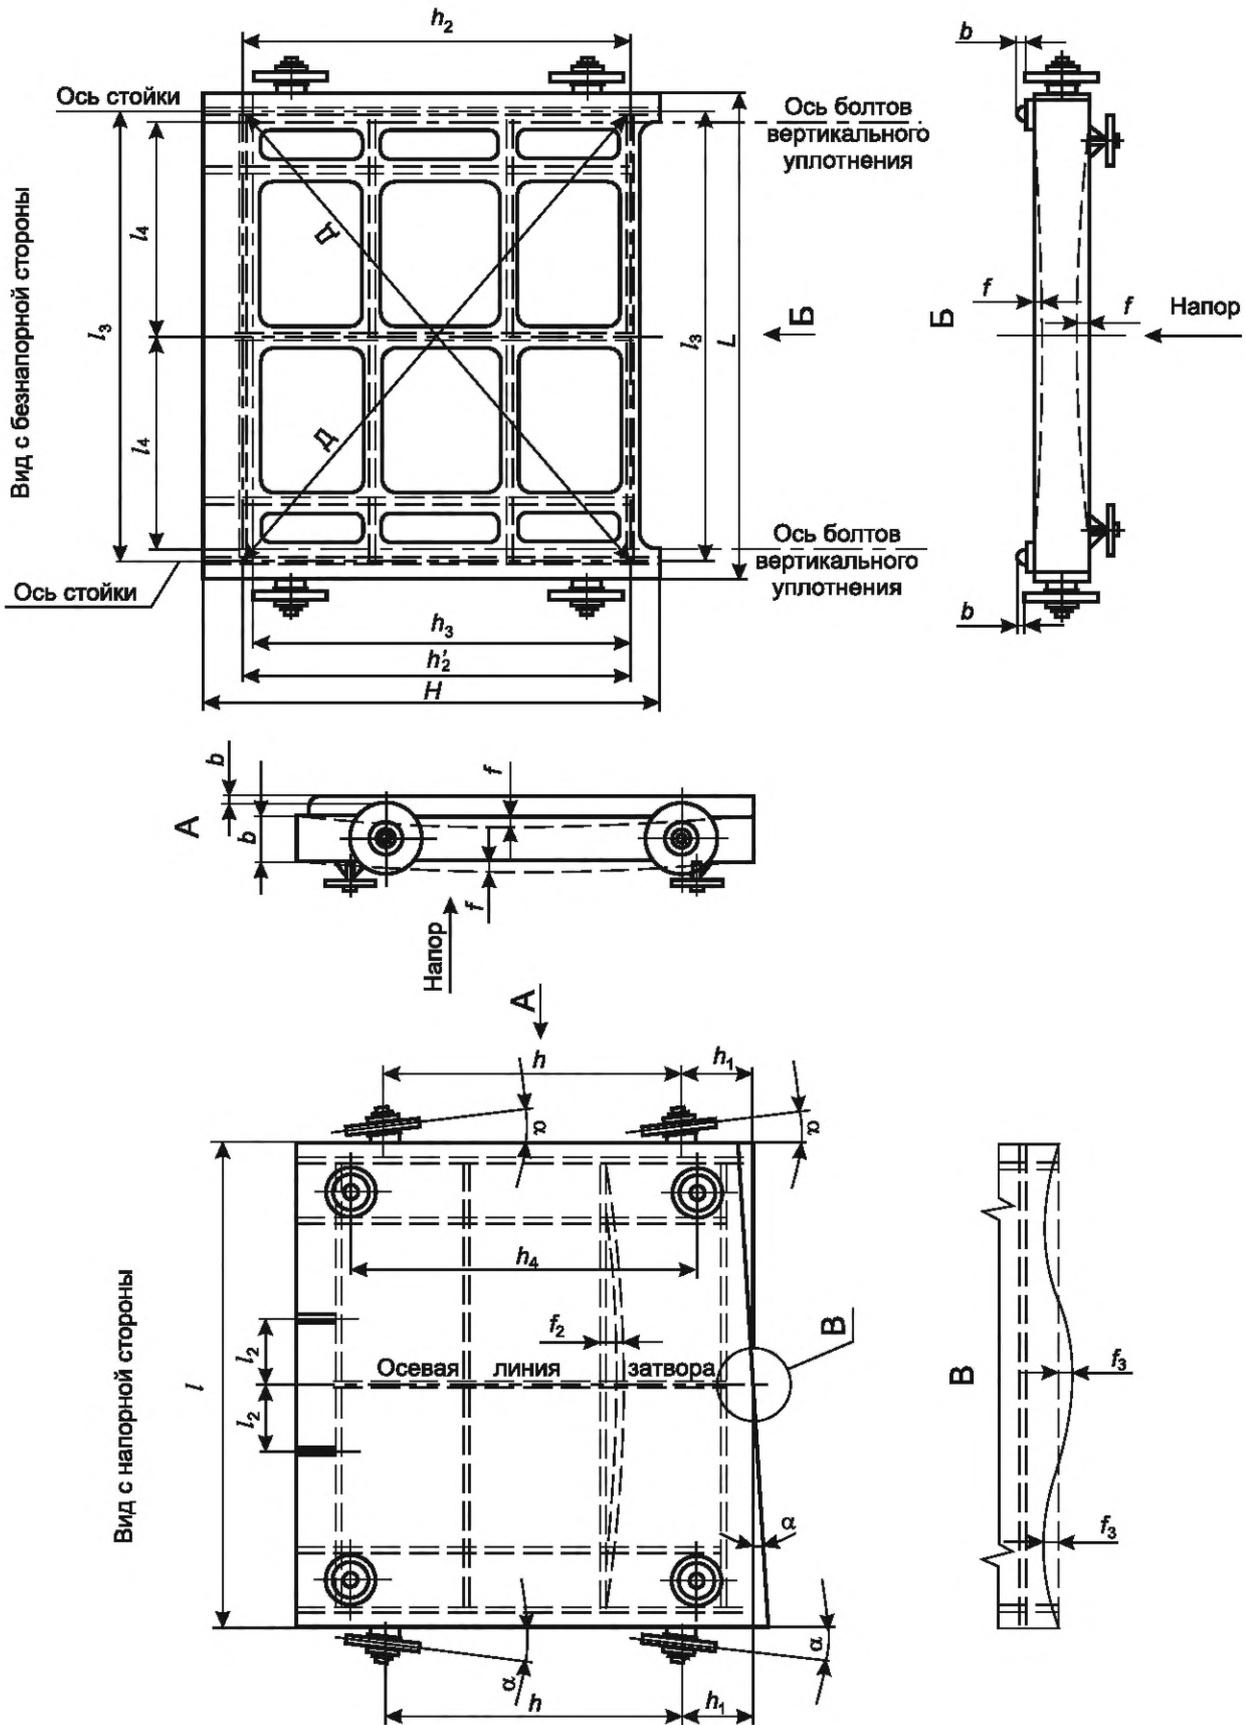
Схема контрольных обмеров плоского колесного затвора
